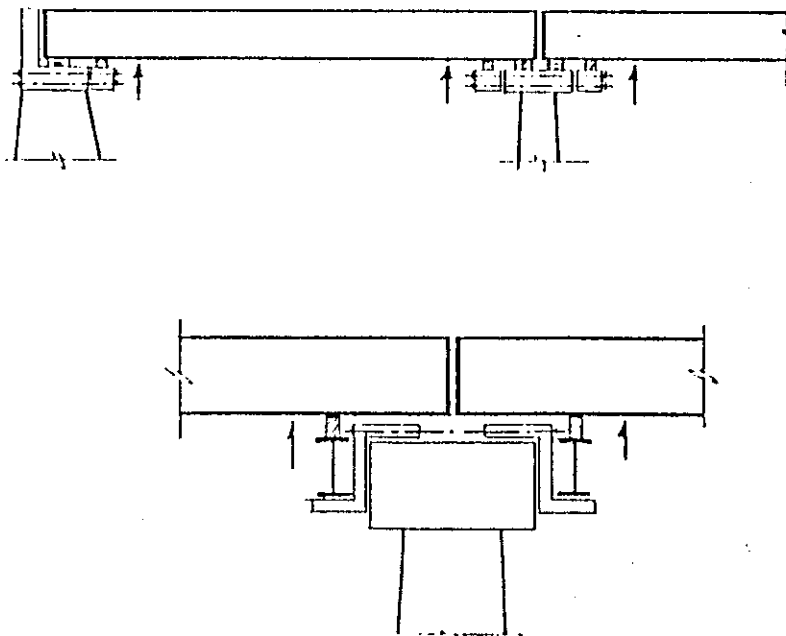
Levantamiento por la viga a partir de una bloque o espacio adicional
